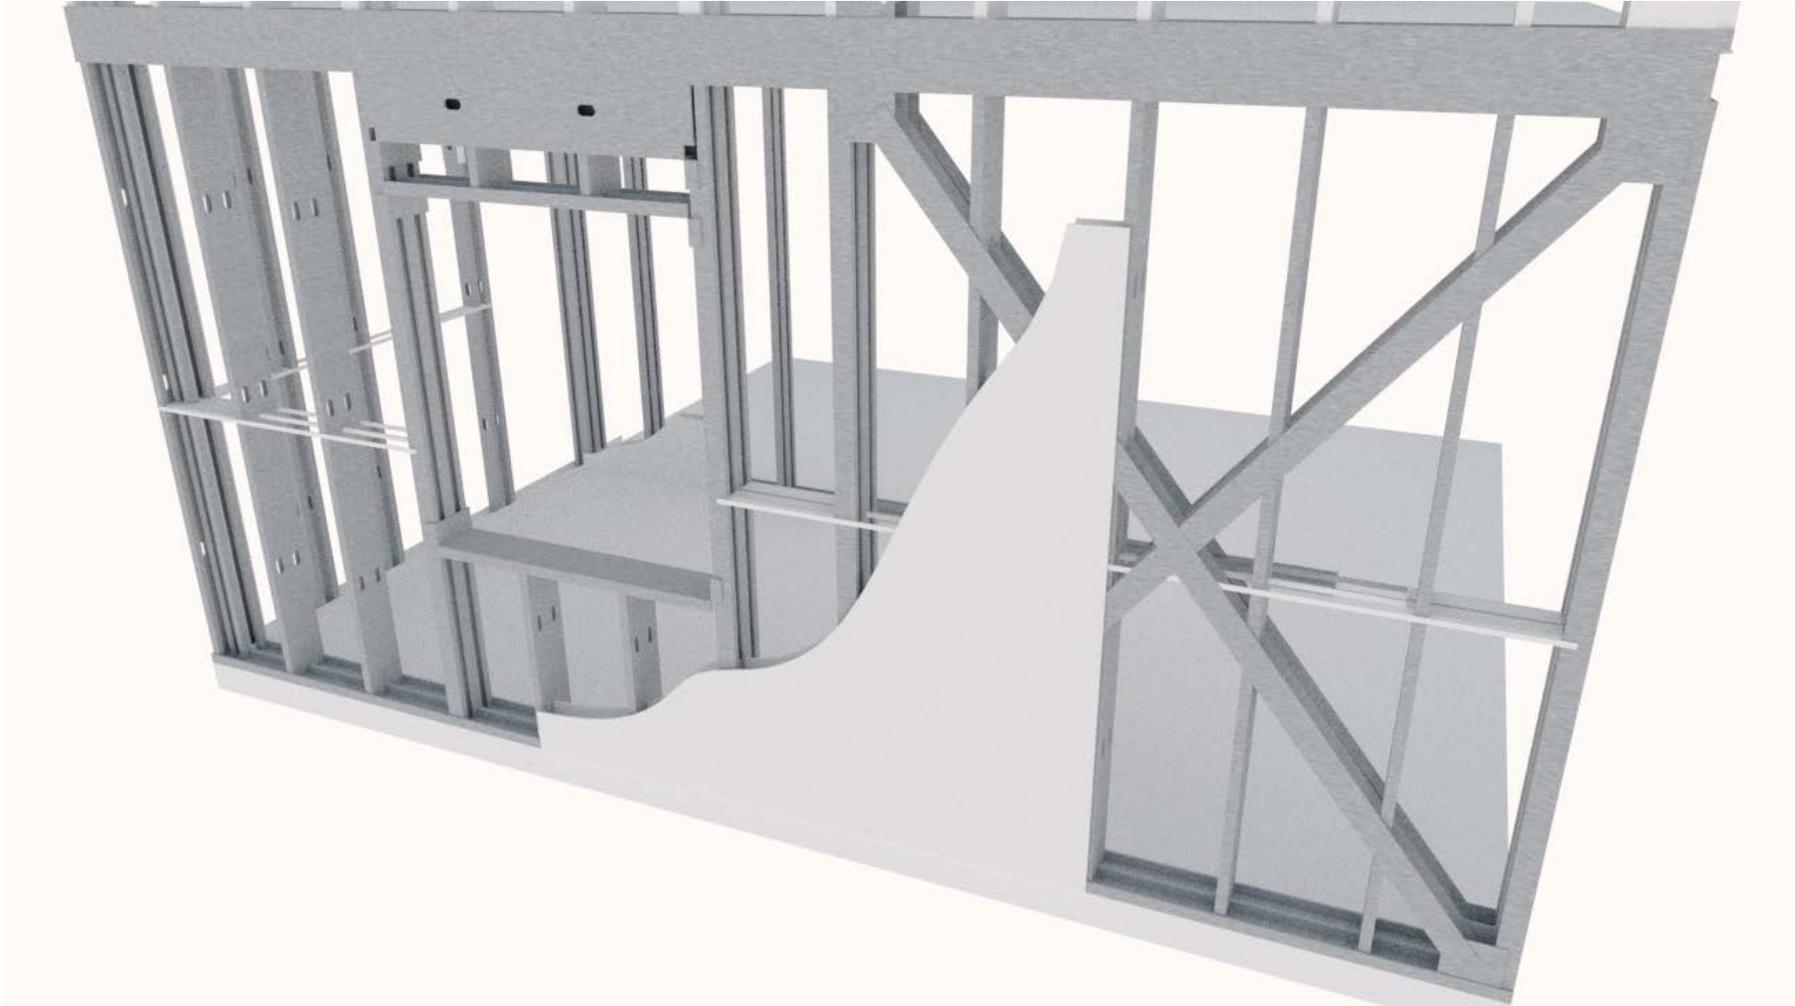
Andino, E. (2020)*. Vista de panel tipo steel framing. Elaboración propia.
